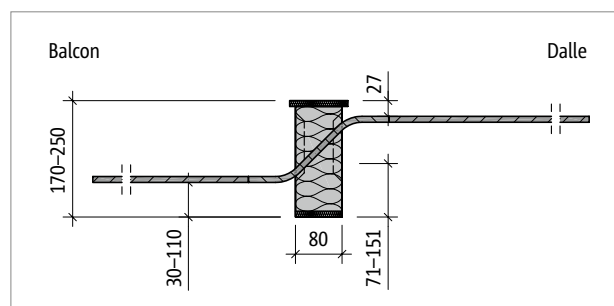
Schöck Isokorb® T type Q-E-Z-V5 : coupe du produit
